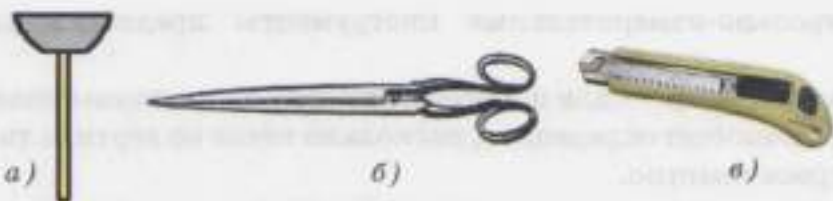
Инструменты для подготовки поверхностей к наклеиванию обоев и для раскроя обоев:
